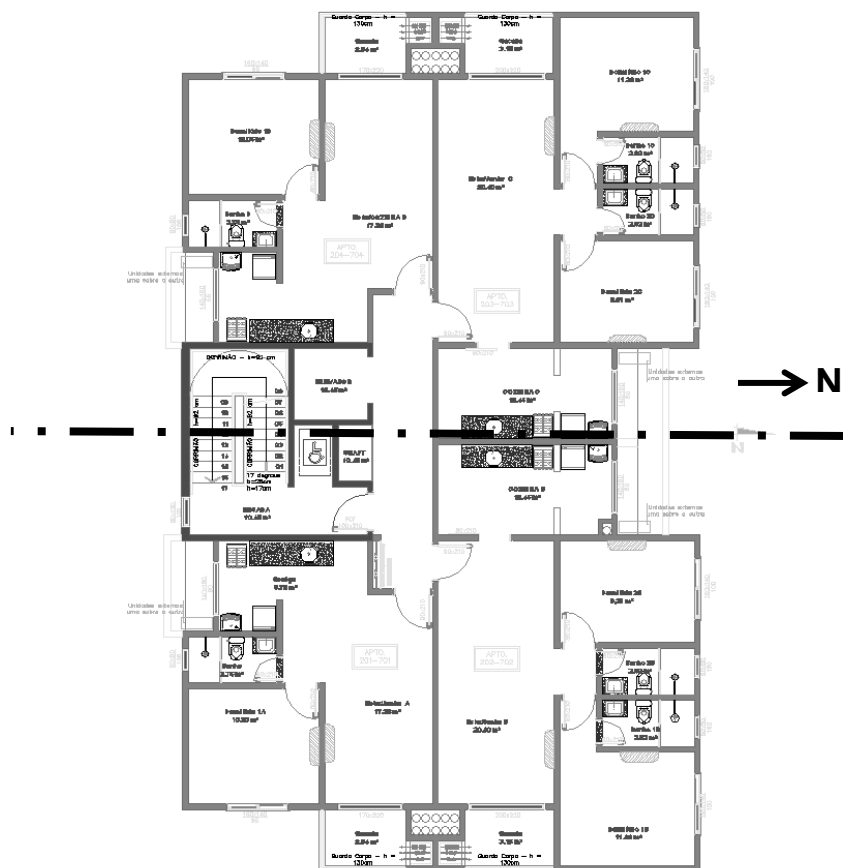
Planta baixa pavimento tipo do Residencial do Parque
